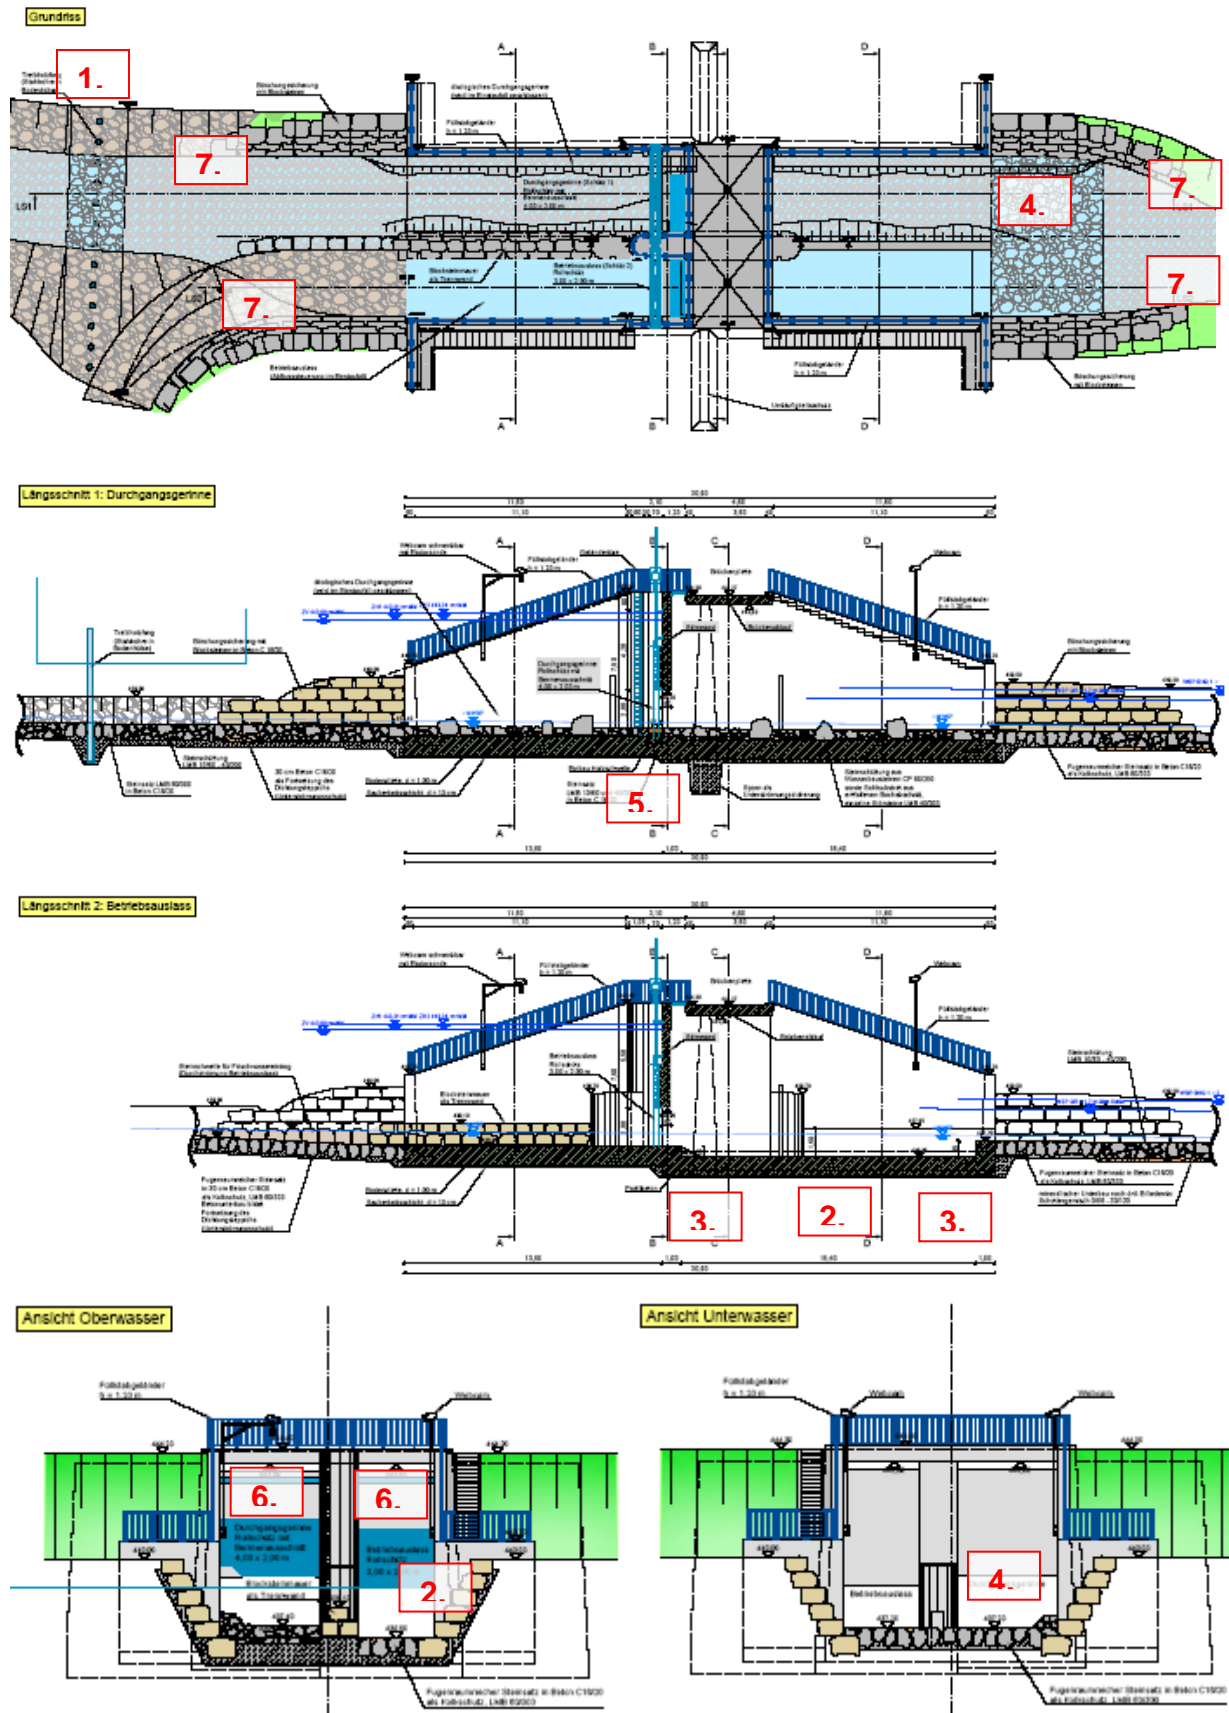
Vorabzug (Grundriss, Längs- und Querschnitte) zum Auslassbauwerk des geplanten HRB Maurener Tal mit Verweisen (rote Nummerierung) auf die oben angeführten Anmerkungen (Kartengrundlage: Ing.-Büro Wald + Corbe)
